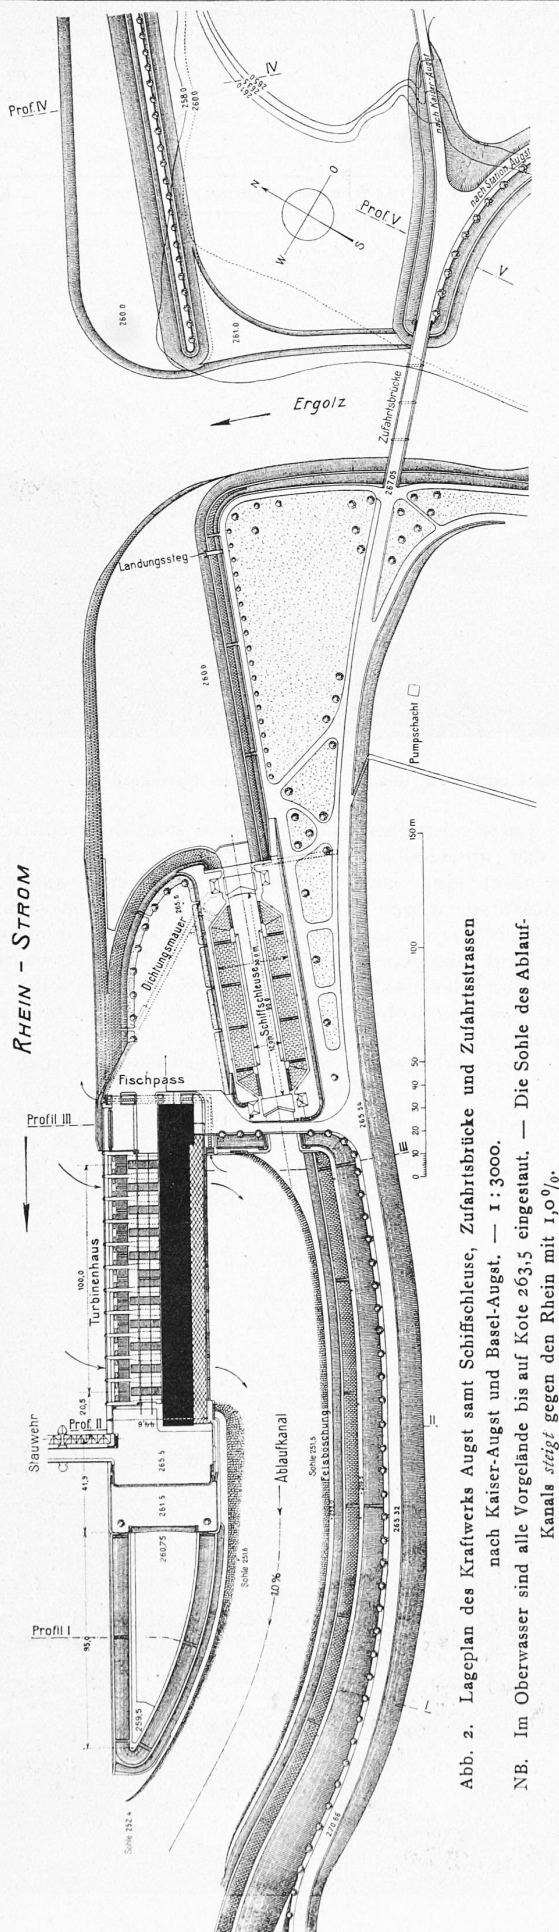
Lageplan des Kraftwerks Augst samt Schiffschleuse, Zufahrtsbrücke und Zufahrtsstrassen nach Kaiser-Augst und Basel-Augst. — 1 : 3000.
